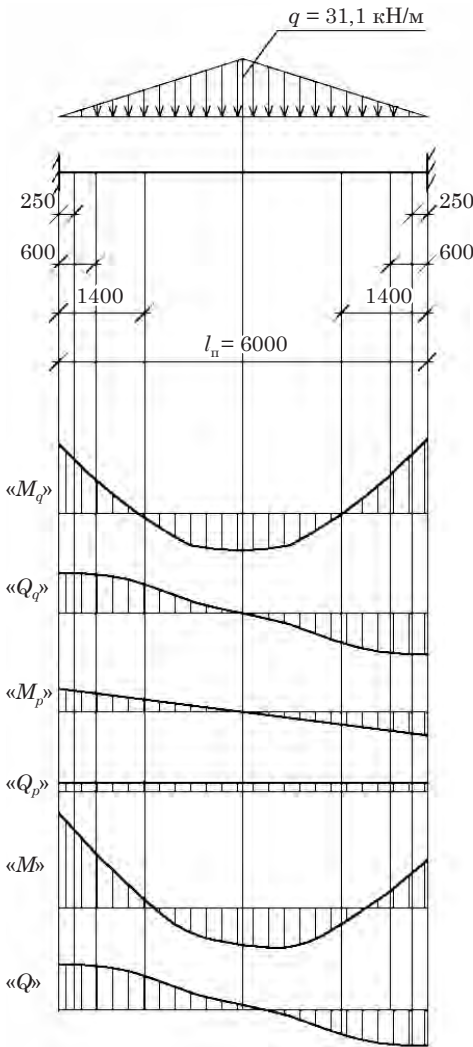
Расчетная схема и эпюры усилий прямого ригеля
